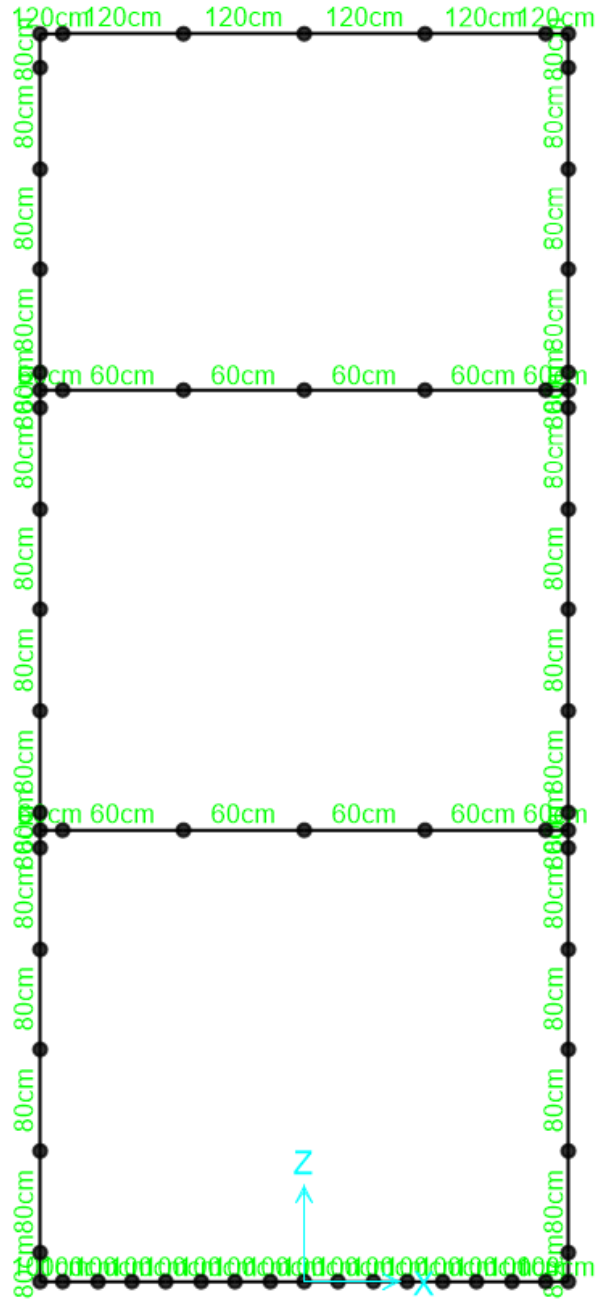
Sezione 1: Schema del modello di calcolo agli elementi finiti: nodi ed elementi frame
